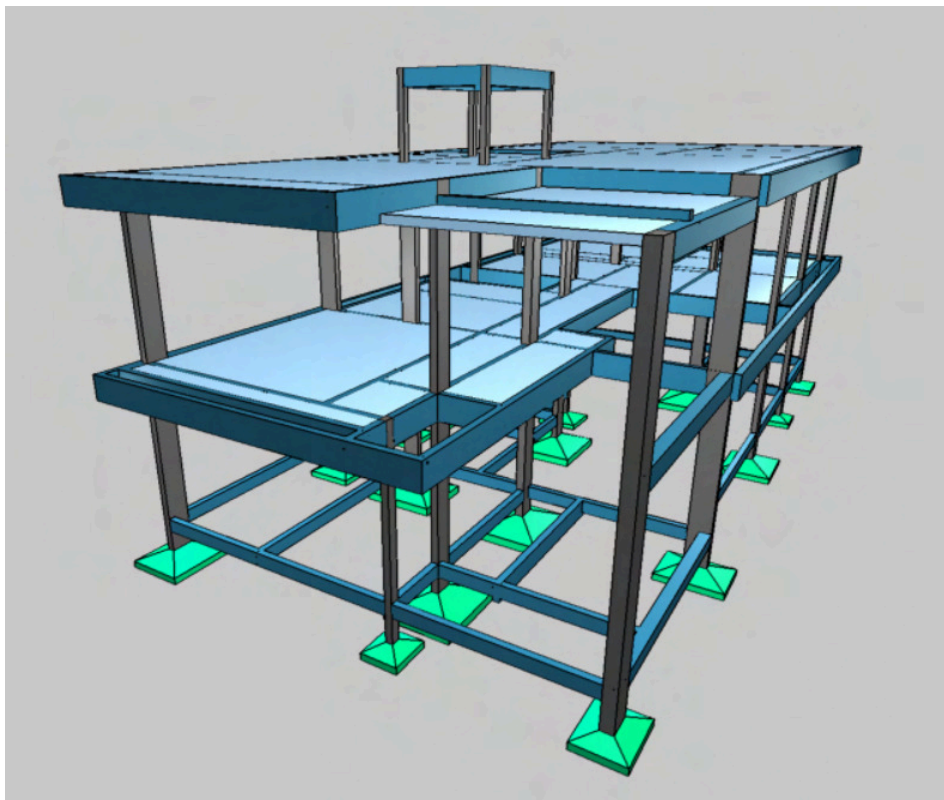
Forma do pavimento superior com laje pré-moldada treliçada - Modelo 1
